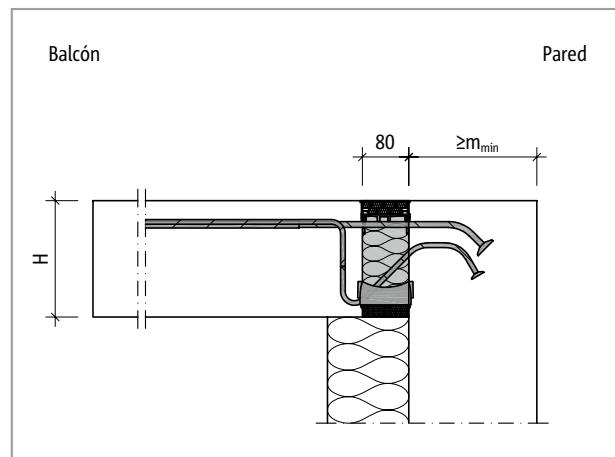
Schöck Isokorb® T tipo K-O: Conexión a pared hacia abajo en caso de aislamiento externo
